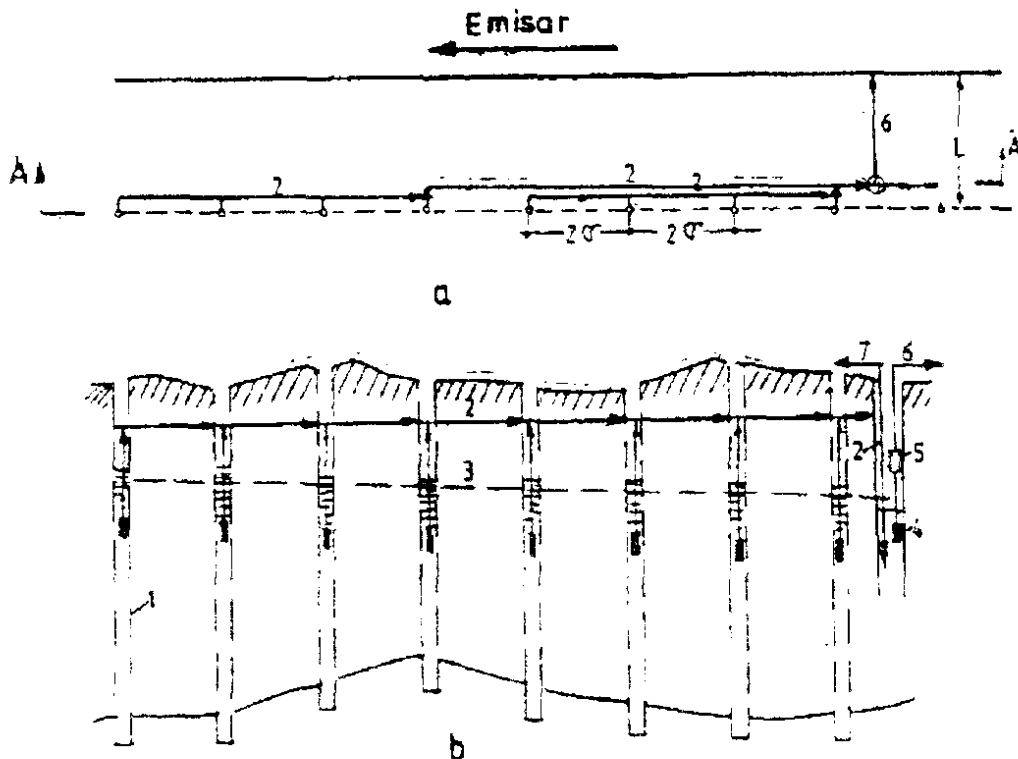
Schema puțurilor sifonate; a — plan; b — secțiune verticală
